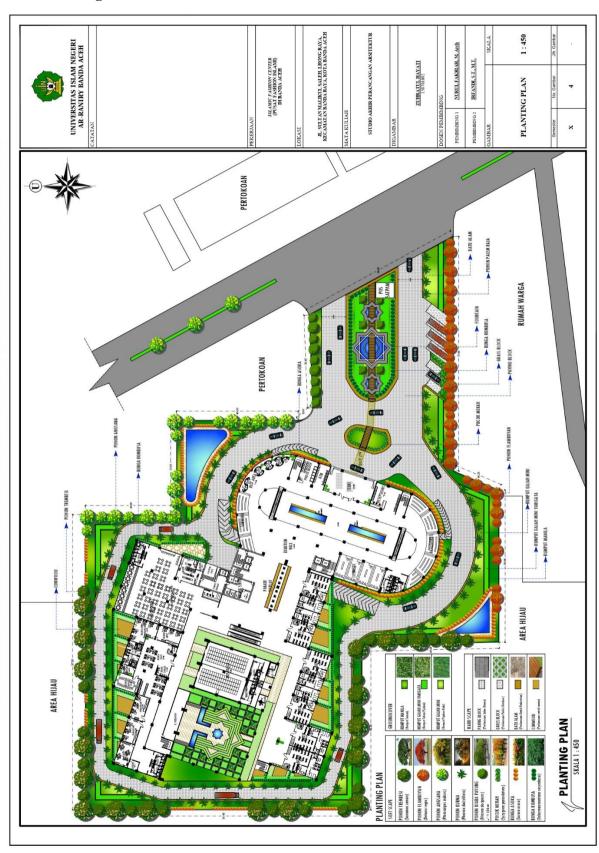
Layout Plan (Sumber : Analisis Pribadi)
